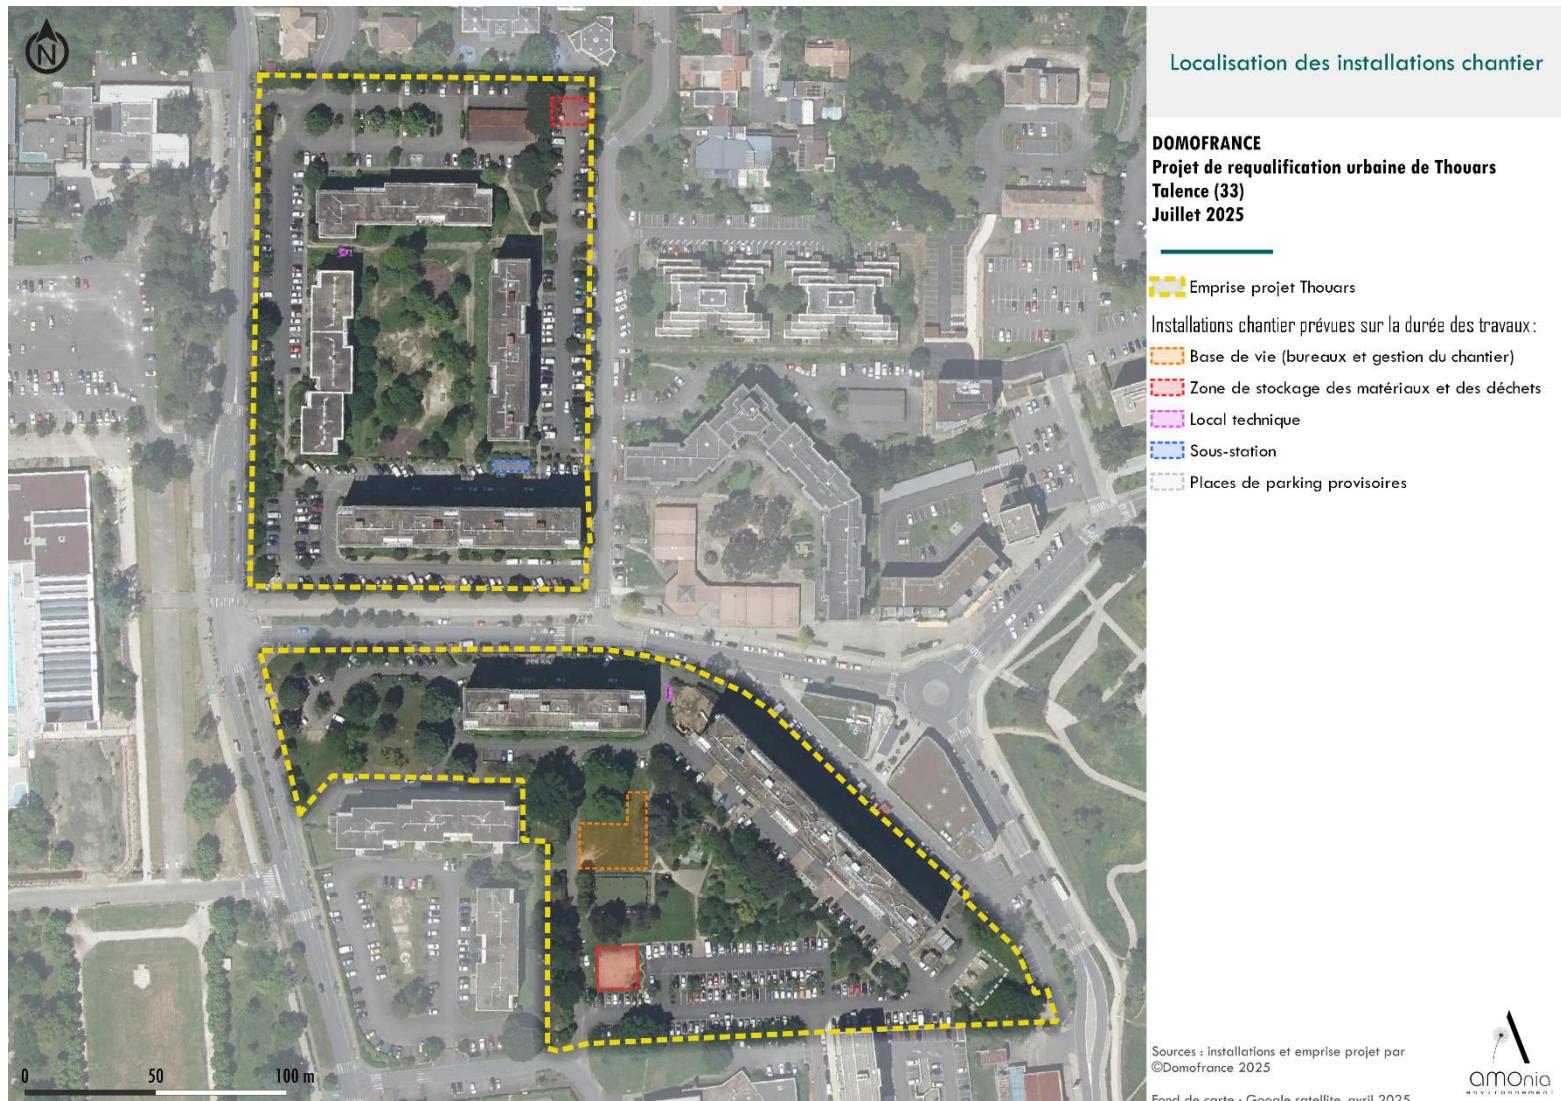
Plan des installations de chantier (Source : AMONIA environnement, 2025)
